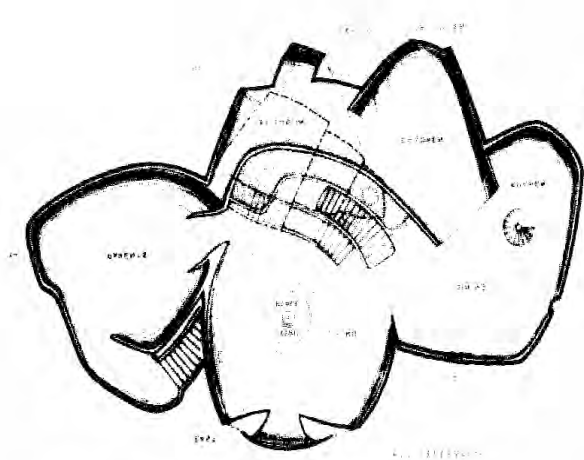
Frederick Kiesler, Endless House, Grundriß
